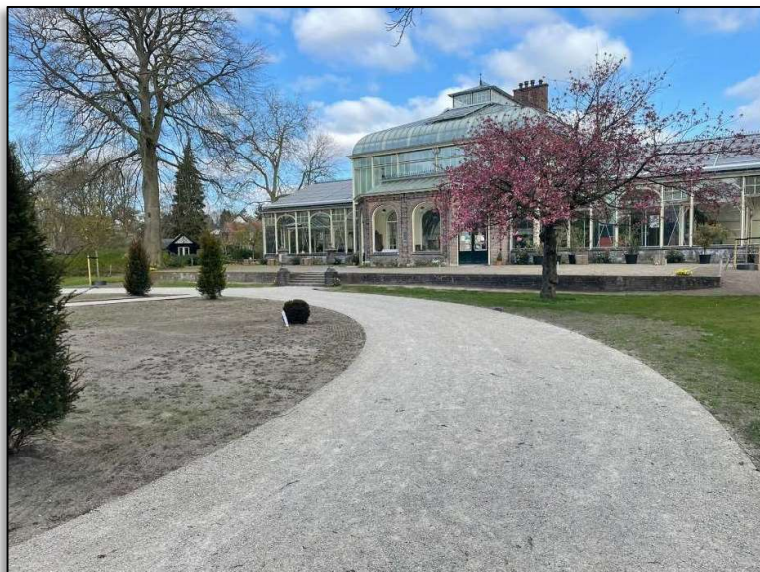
Cantonspark: renovatiewerkzaamheden in afronding.
